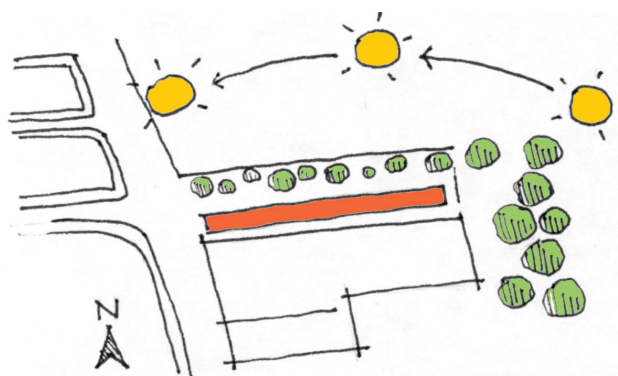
Esquema de estrategia por orientación. Elaboración propia
